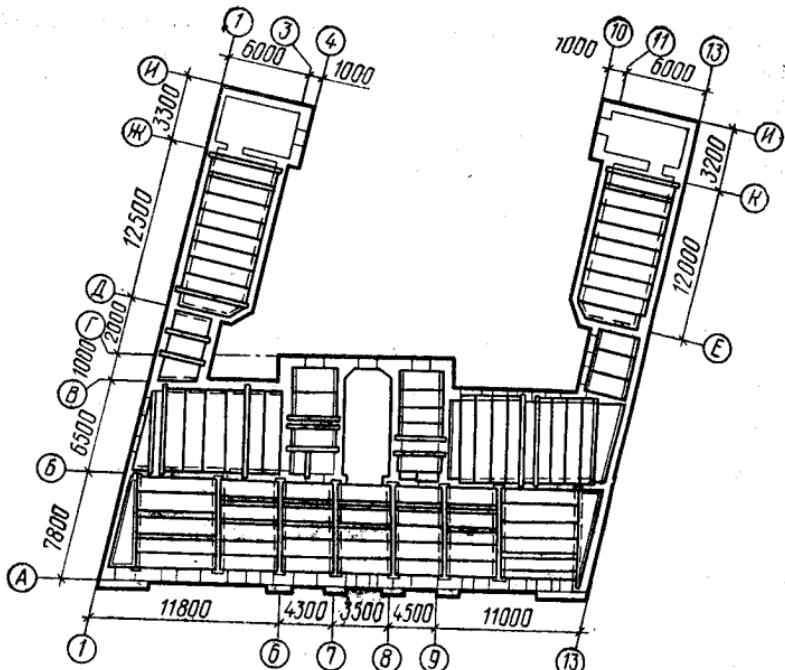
План раскладки железобетонных плит настила перекрытия типового этажа жилого дома (г. Харьков)
